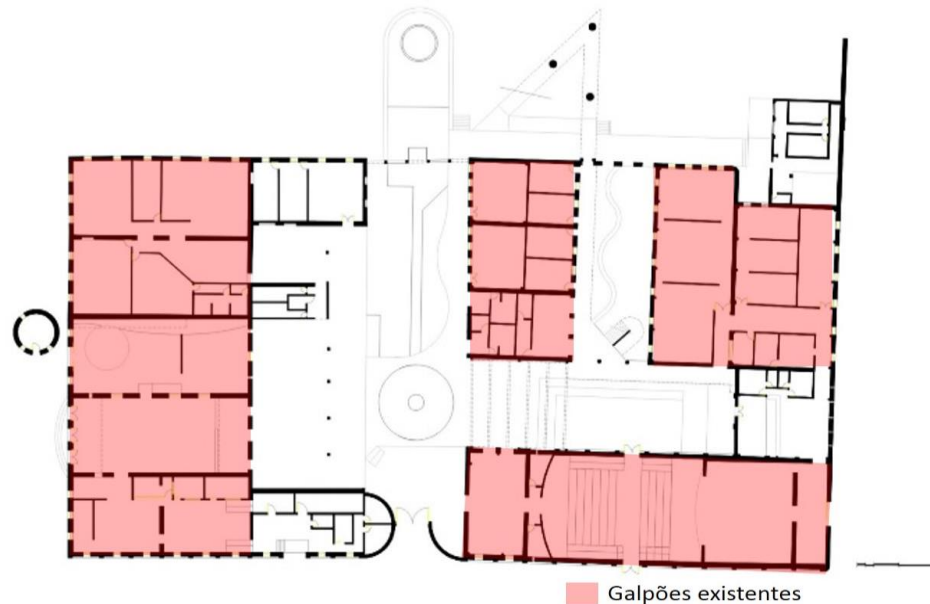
Planta Baixa dos galpões do ECOA. Sobral/Ce.
